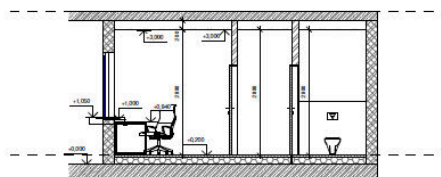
Příklad zázemí dopravce s jednou pokladní přepážkou
